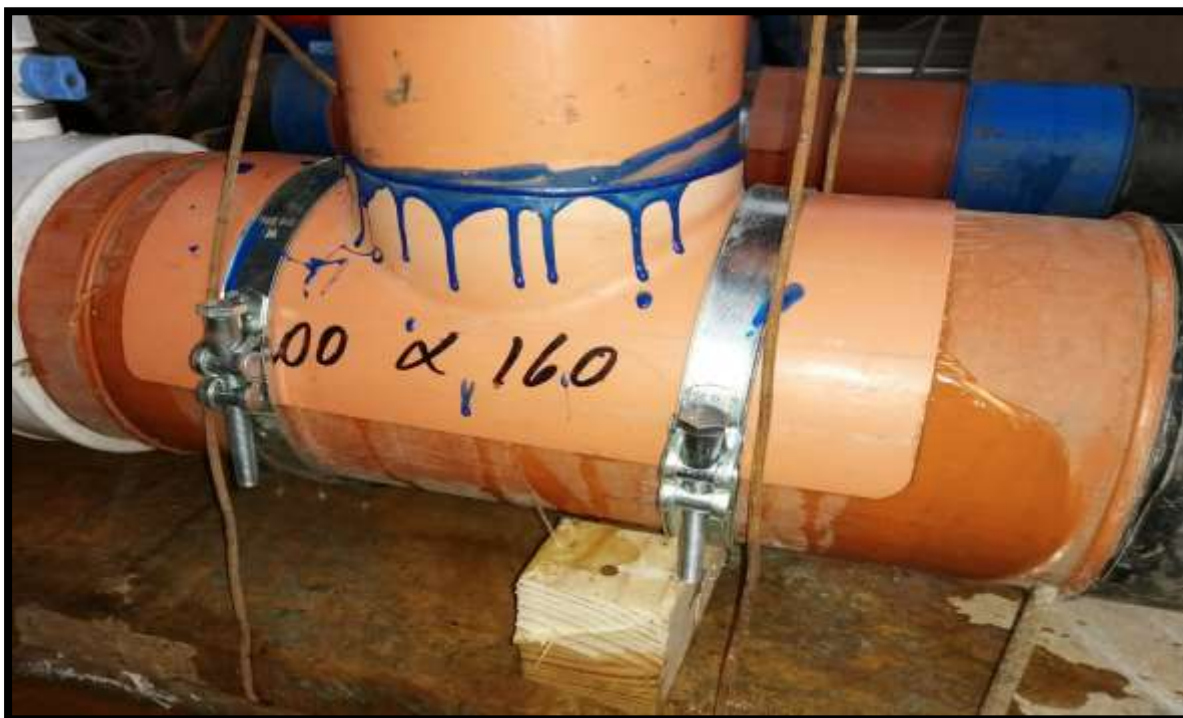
Fuga de agua a una presión de 2lbs, por las paredes entre la tubería y el accesorio
